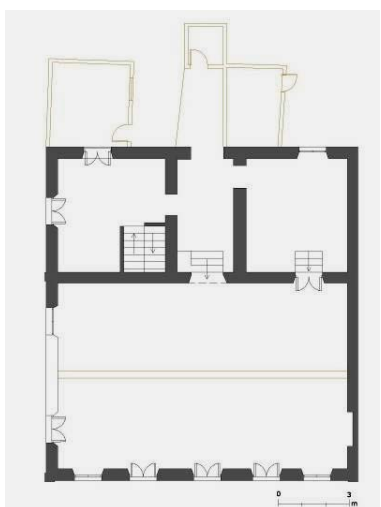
Planta casa Rua Oswaldo Aranha 1872.
